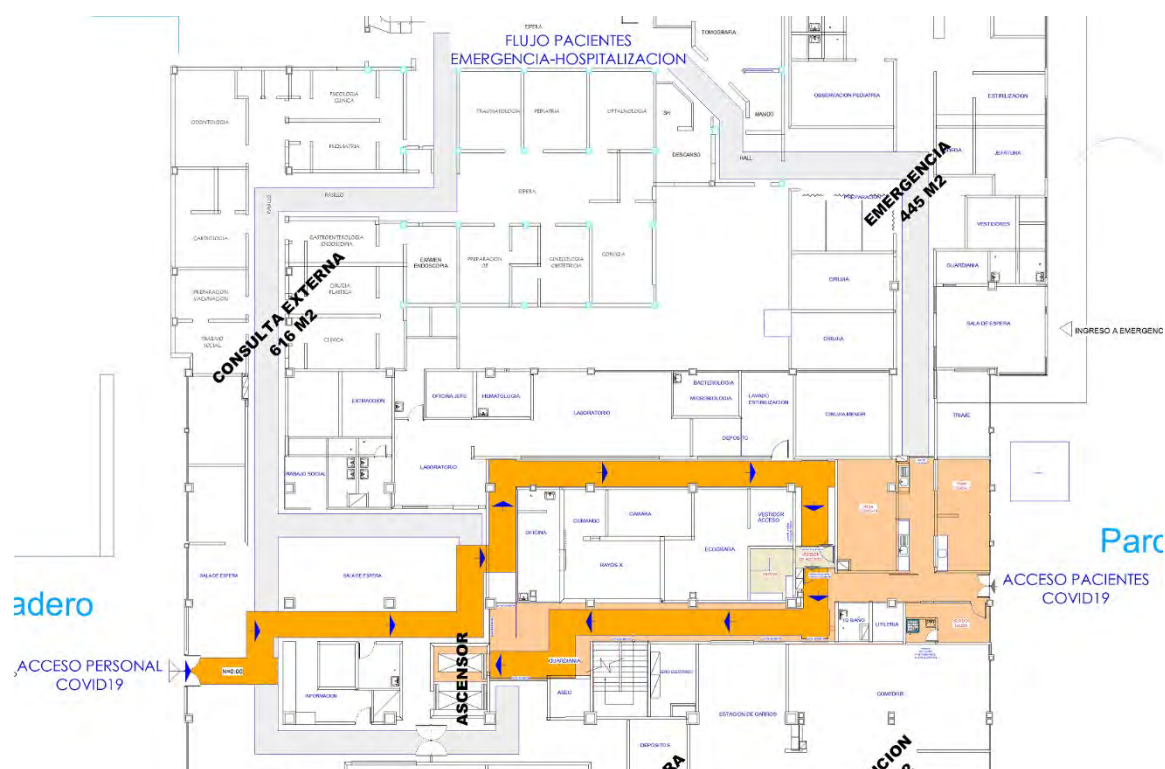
Adecuación de flujos en planta baja del Bloque “A”.
